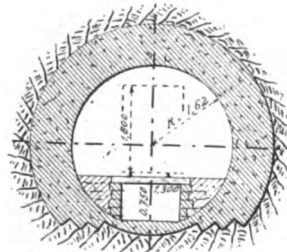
Cuvelage en maçonnerie de béton au mortier de ciment.
